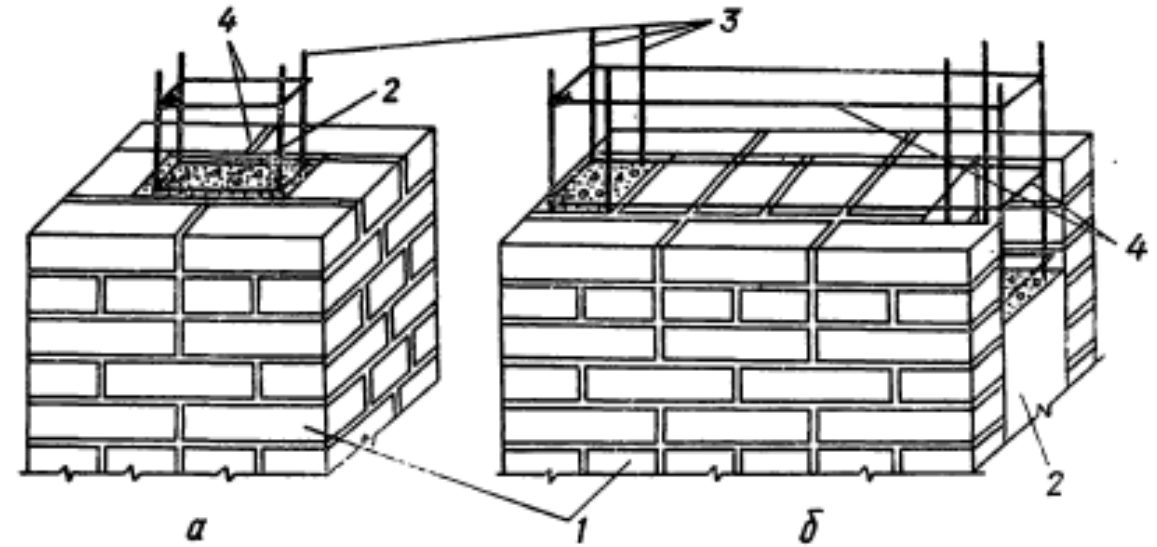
Элементы кирпичной кладки, усиленные железобетоном (комплексная конструкция):
